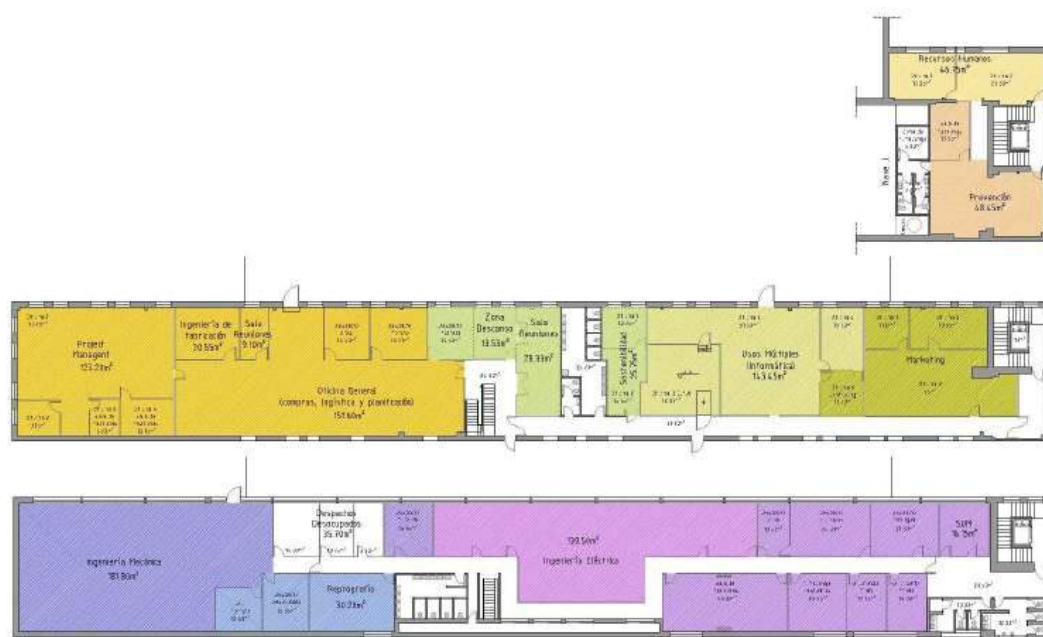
Plano planta Oficinas Torre Transformadores Córdoba
